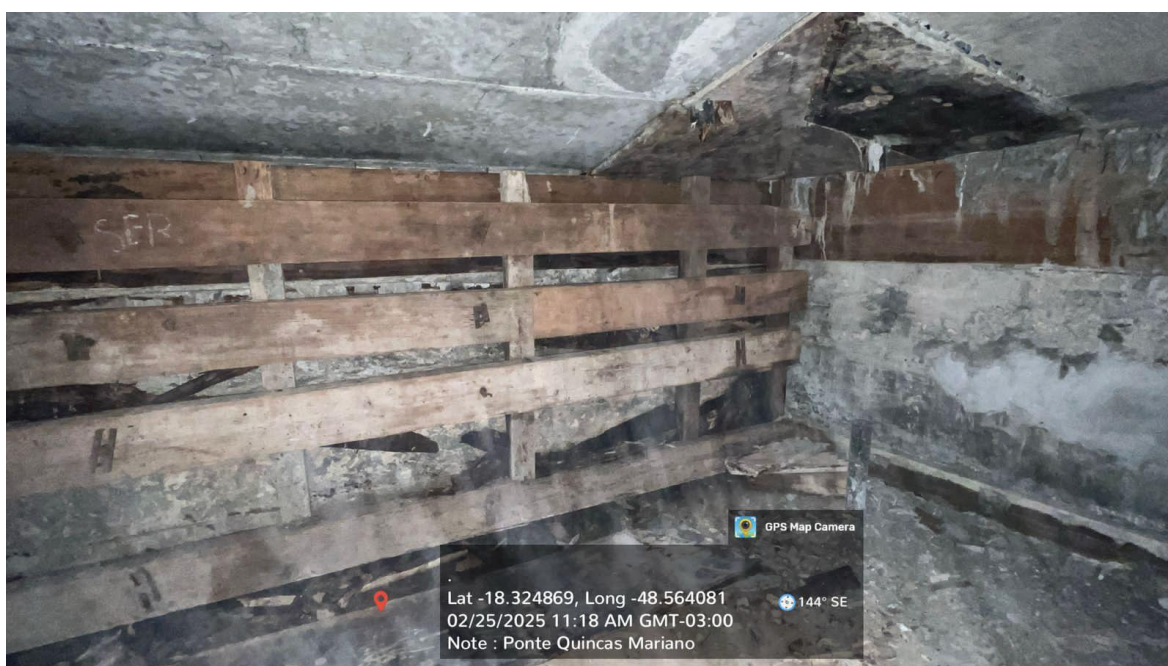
Vista aproximada das “paredes” da parte interna da estrutura localizada entre os pilares P6 e P7, íntegras e sem identificação de patologia que comprometa sua função estrutural
